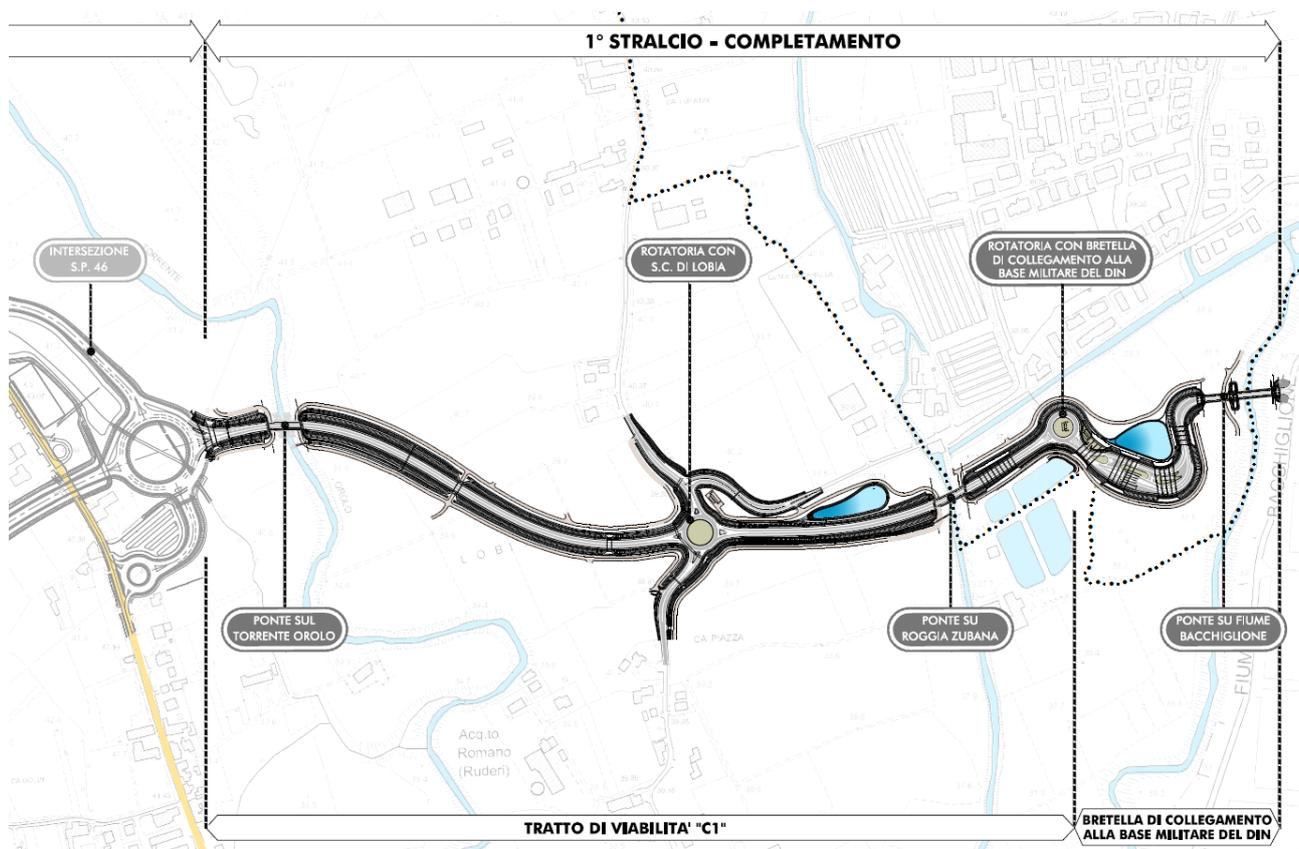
PLANIMETRIA D'INSIEME DEL PROGETTO DELL'INFRASTRUTTURA
